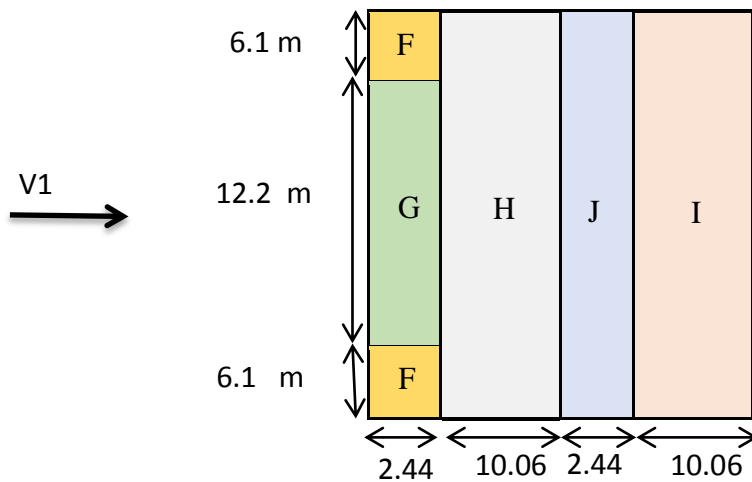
Vue en plan des zones de pression sur la toiture suivant le long pan.
